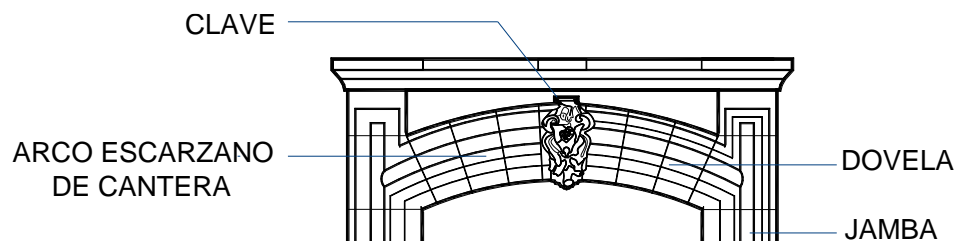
Detalle del cerramiento del portón de la vivienda.
